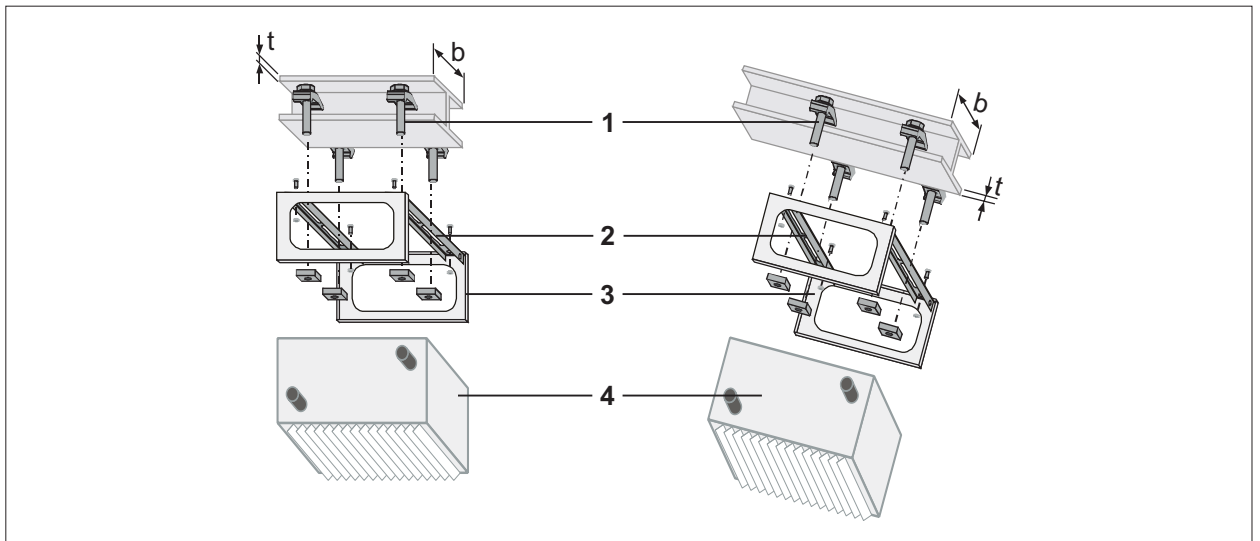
Монтаж воздухонагревателя на стальной балке напрямую
